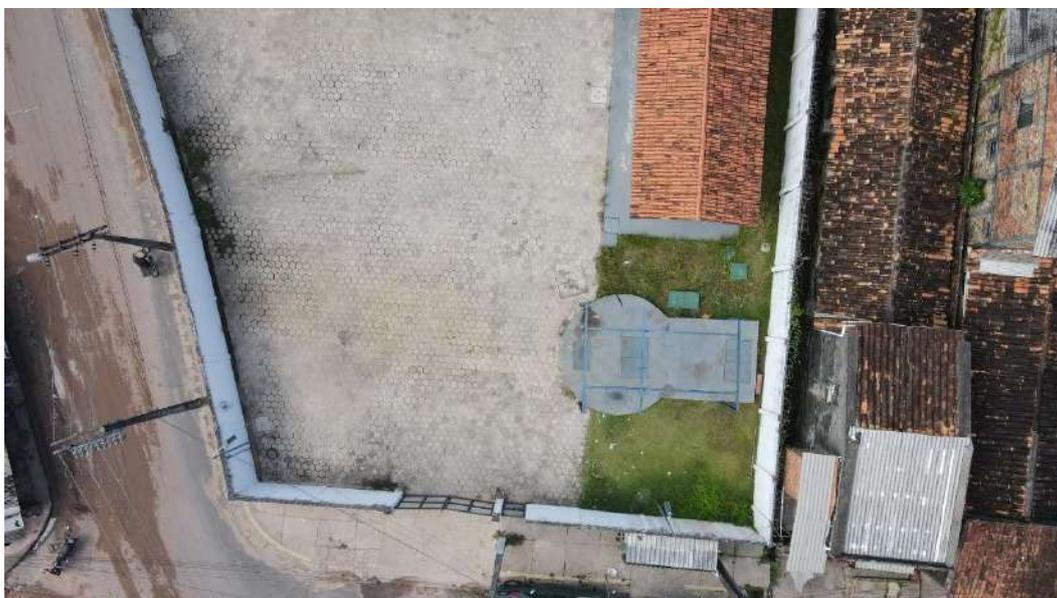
BEL082-ETE Tucunduba, elevatória de esgoto.
